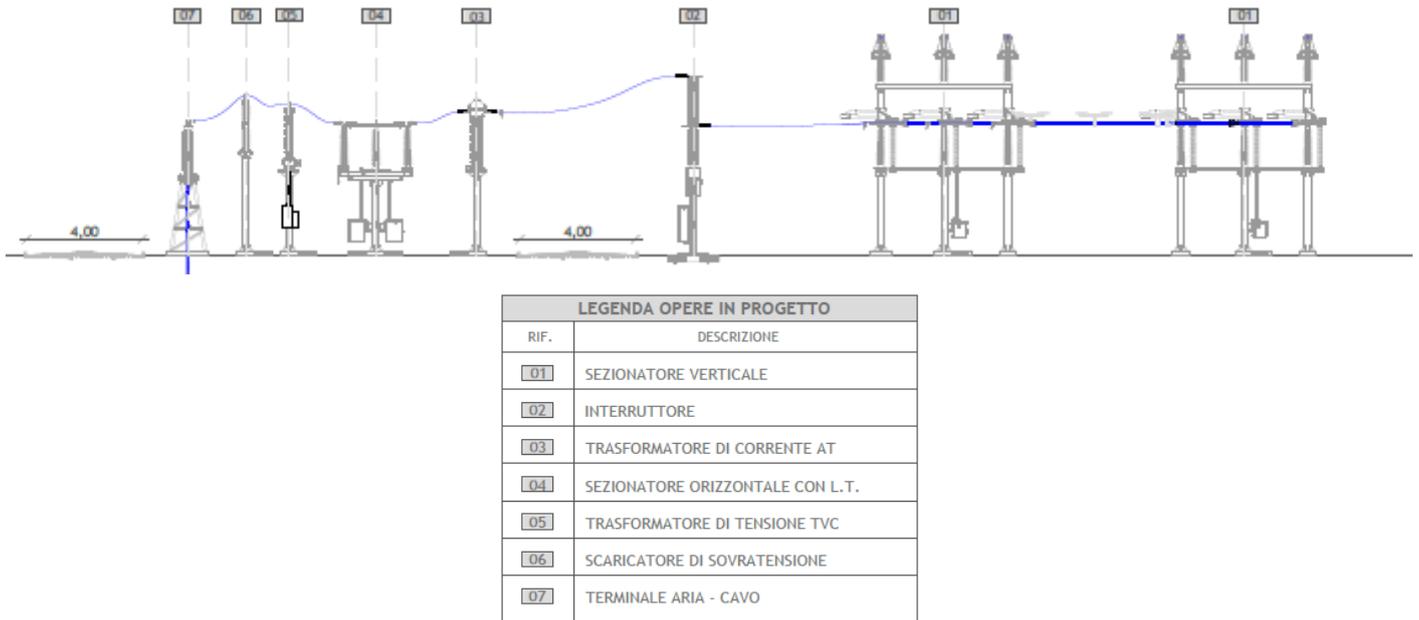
Planimetria e sezione elettromeccanica impianto di rete per la connessione
